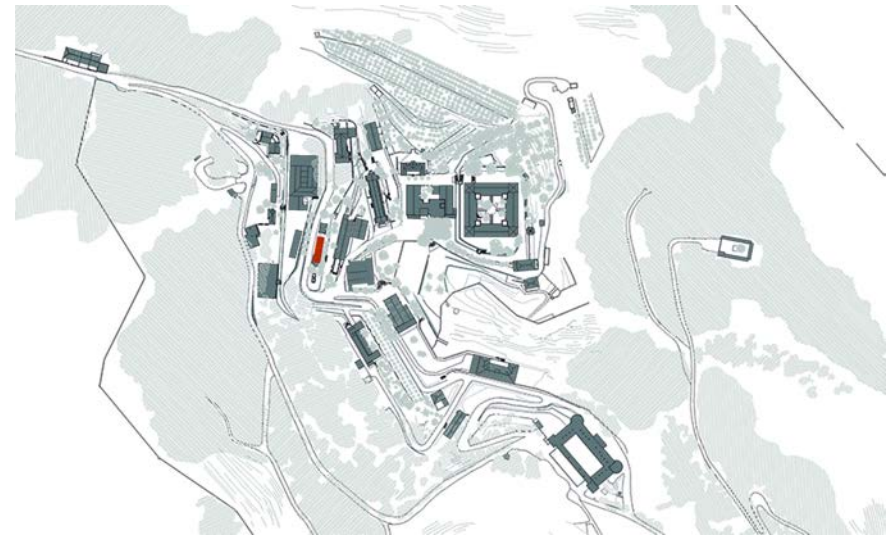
Plano de emplazamiento. Pabellón de San Rafael.
